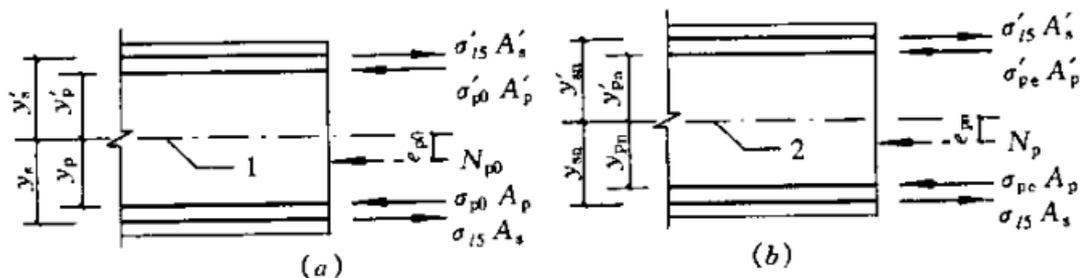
预应力钢筋及非预应力钢筋合力位置
